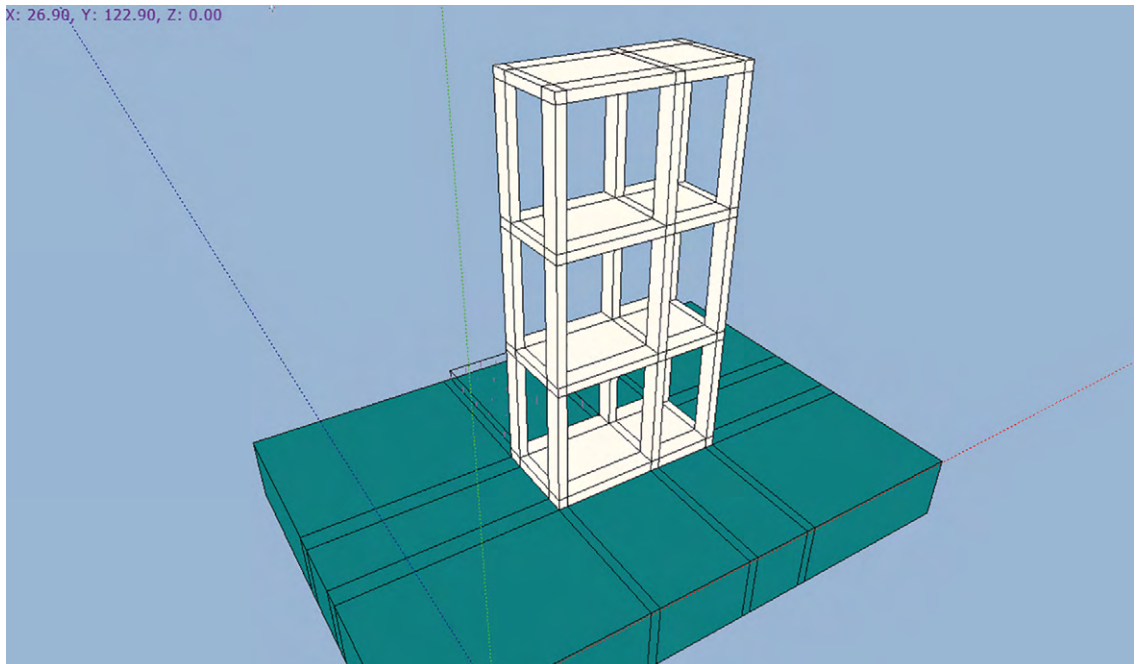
Общий вид расчетной области модельной задачи (белый цвет – железобетон, зеленый цвет – грунтовое основание)
